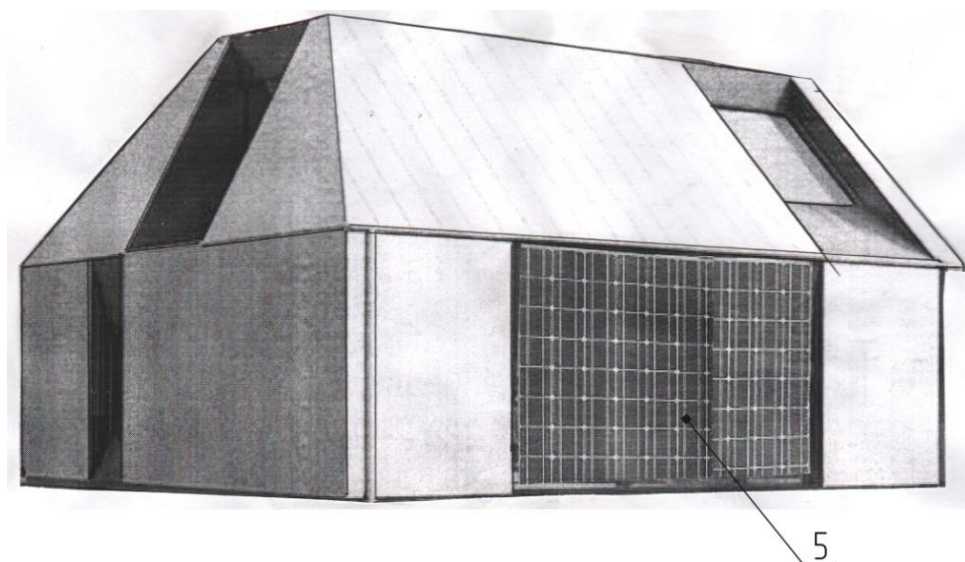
Общий вид динамического энергосберегающего фасада здания с изменяемыми свойствами, работающего в режиме 2
